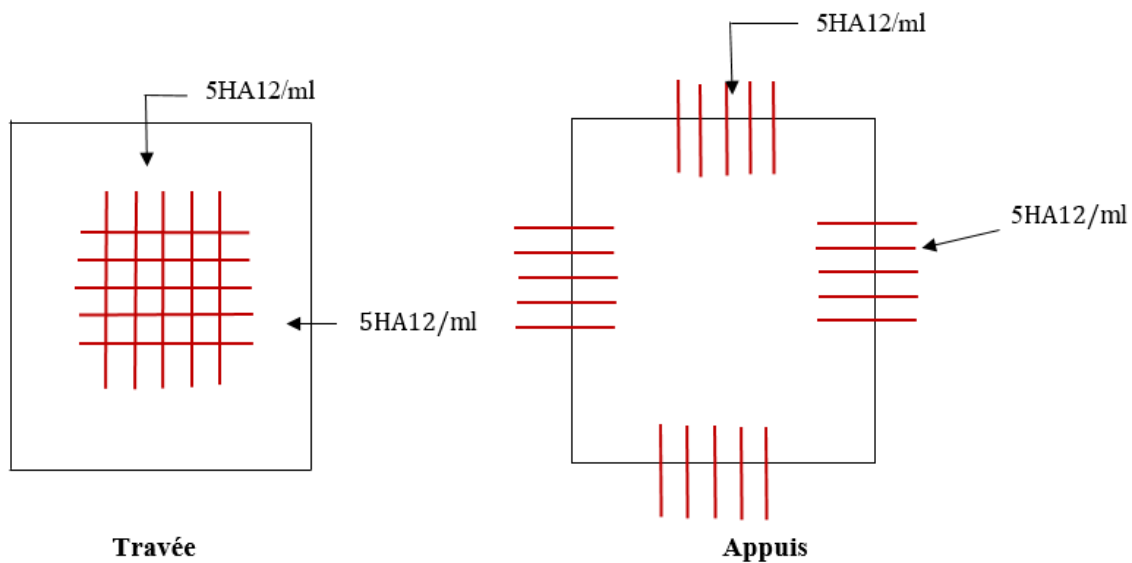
Schéma de ferrailage de dalle d'ascenseur.
